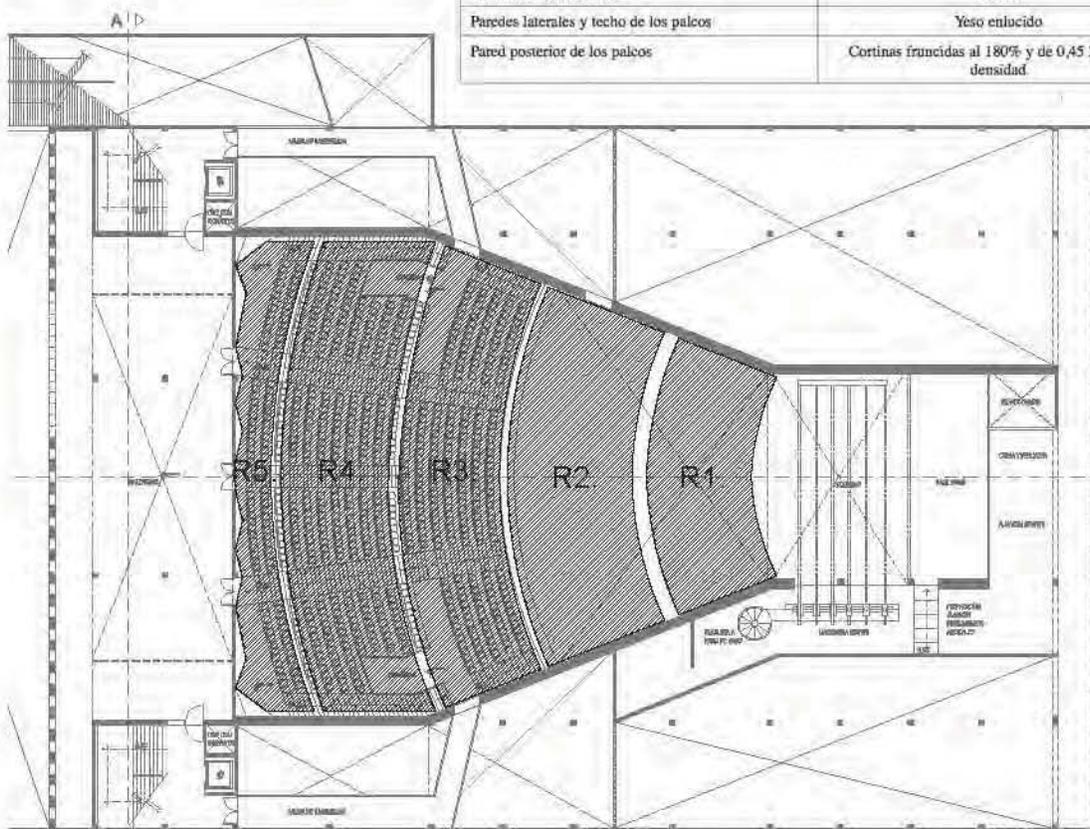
Plafones acústicos, ubicación en planta. Vista en planta de los reflectores de sonido suspendidos en el techo en base al diseño acústico.
